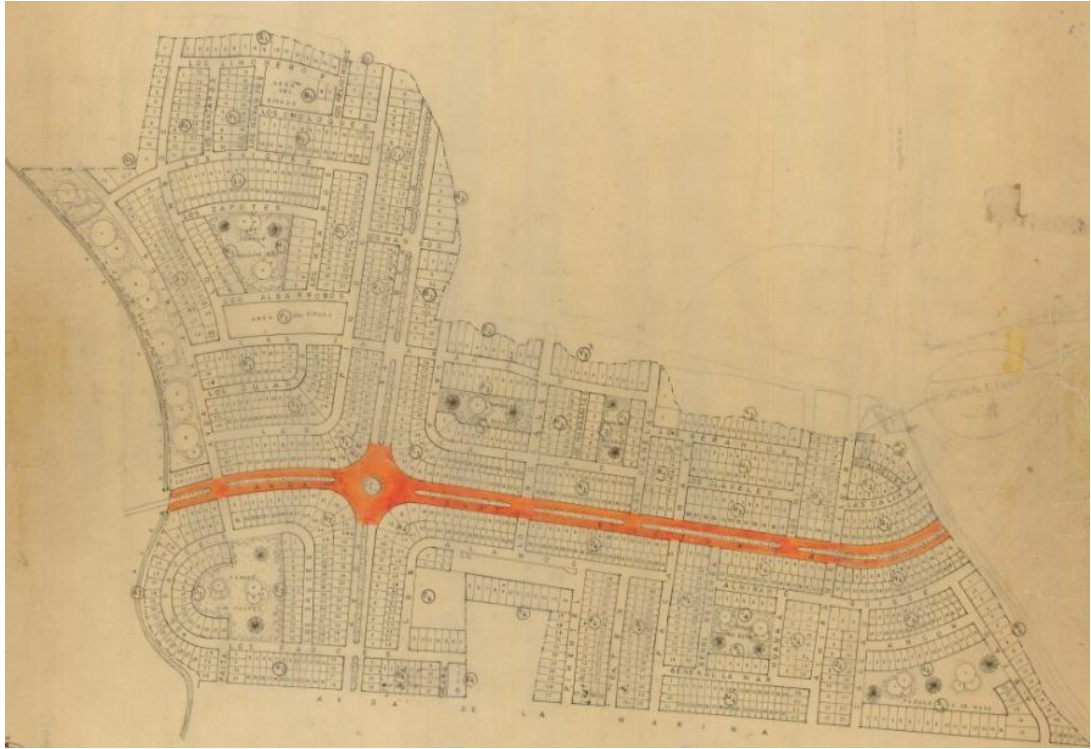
Plano urb. Santa Victoria. Fuente: Gerencia de Urbanismo - Chiclayo.
